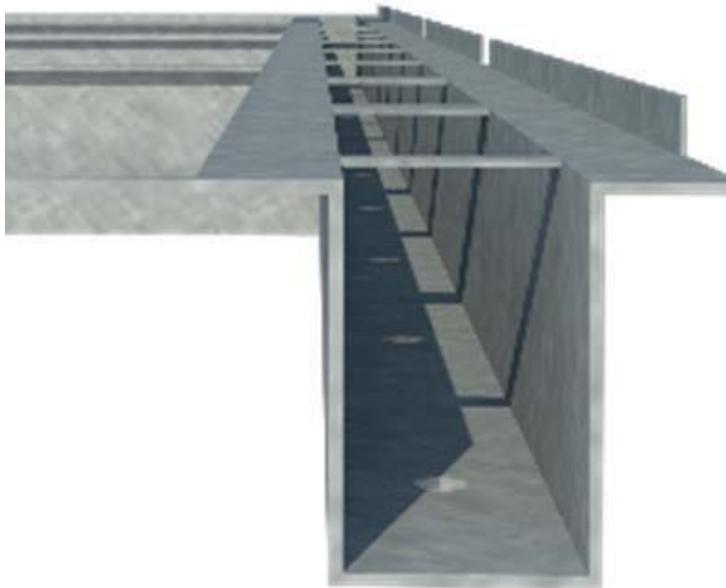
Detalle del canal con barrenos que funcionan para unir el Hábitat con la estructura portante desde el interior del módulo.
